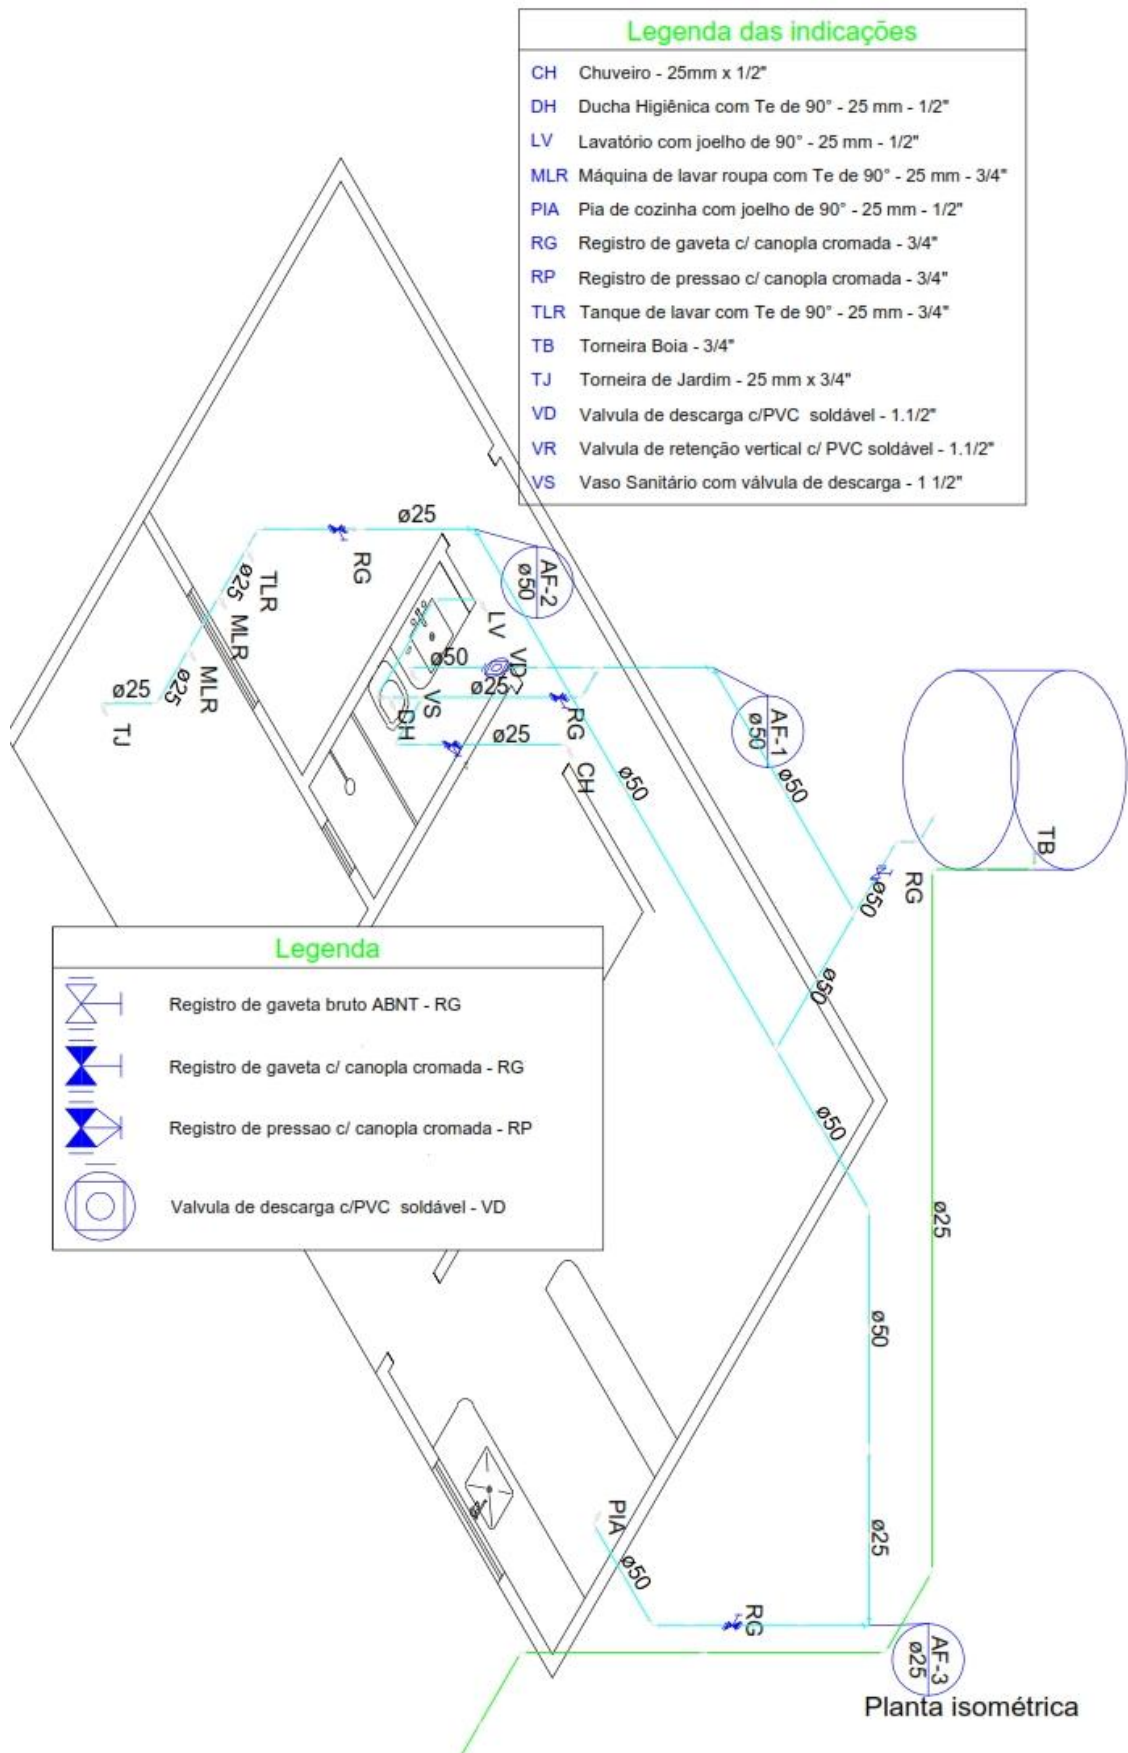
Projeto de água fria em planta baixa sem sistema de distribuição de água pluvial
